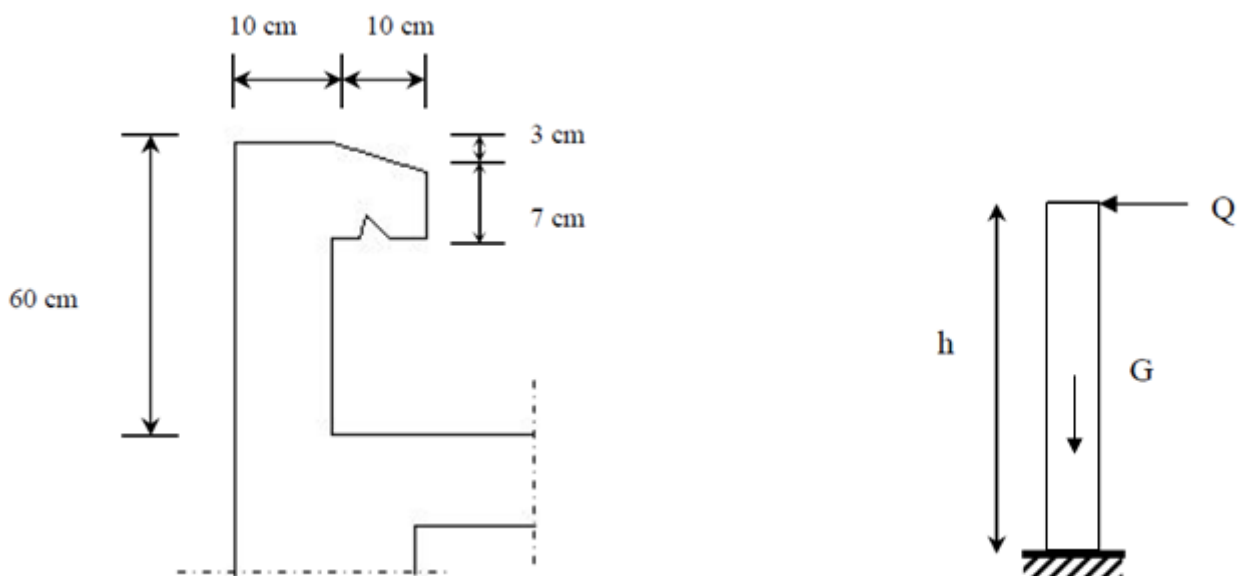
Coupe transversale et schémas statique de l'acrotère
